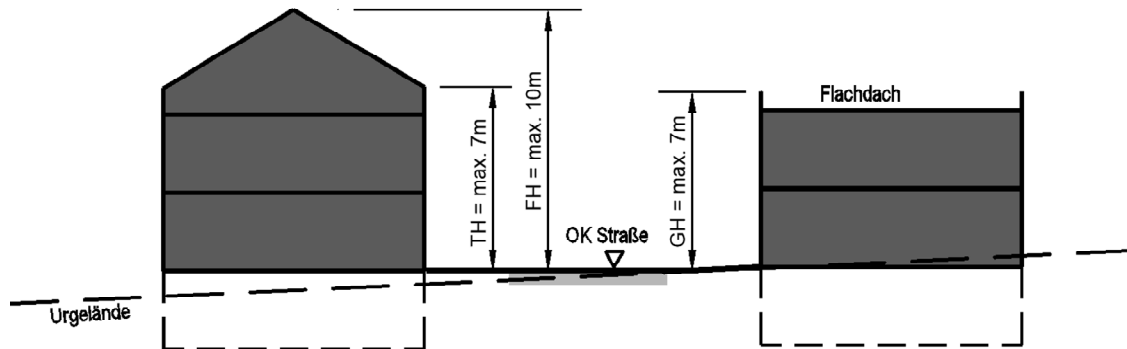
Schemaschnitt mit Gebäudehöhen – unmaßstäblich
